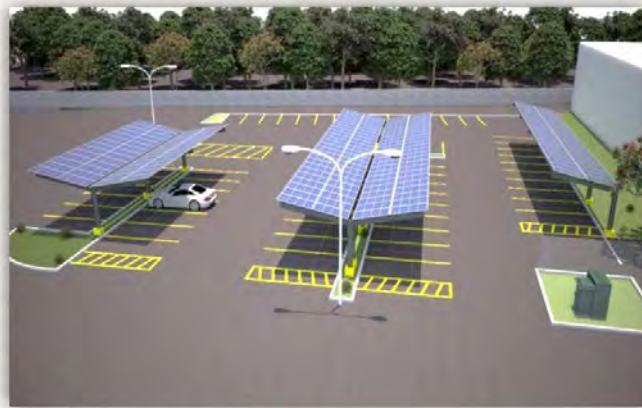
Proyecto: instalación de paneles solares. Campus Apatzingán, Michoacán
